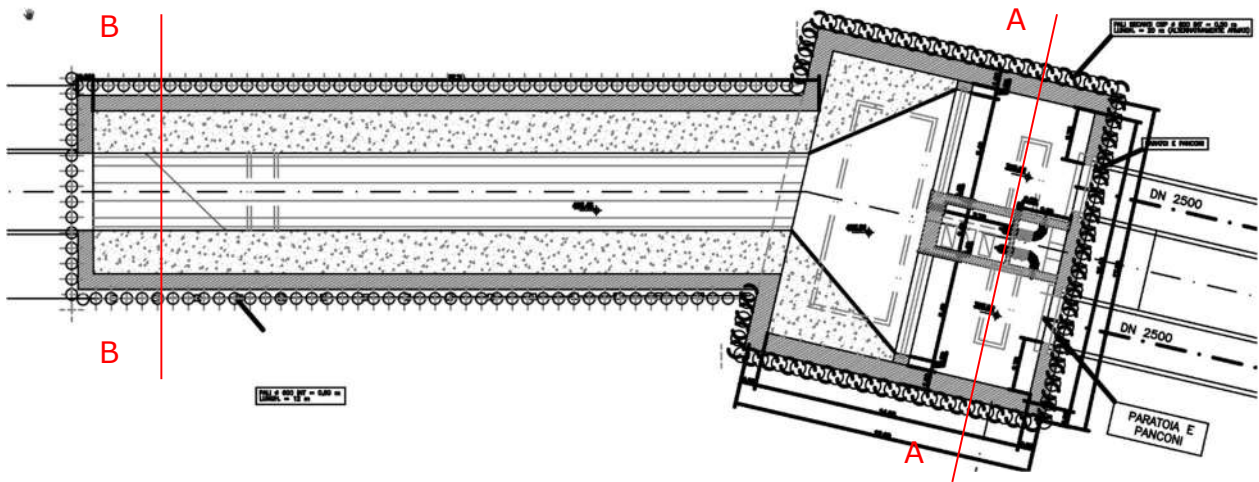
Posizione delle sezioni di calcolo delle opere provvisorie
